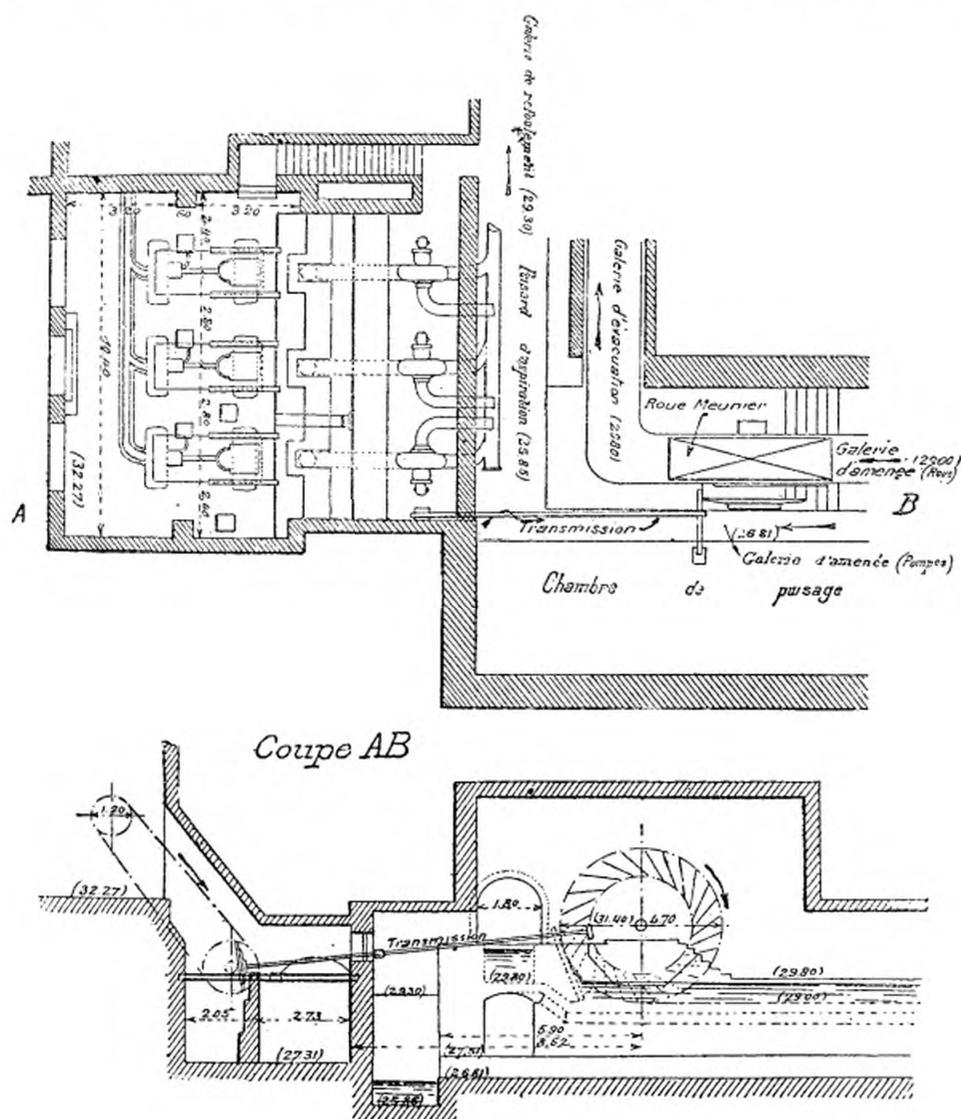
Plan d'ensemble et coupe partielle de l'Usine Mazas.
